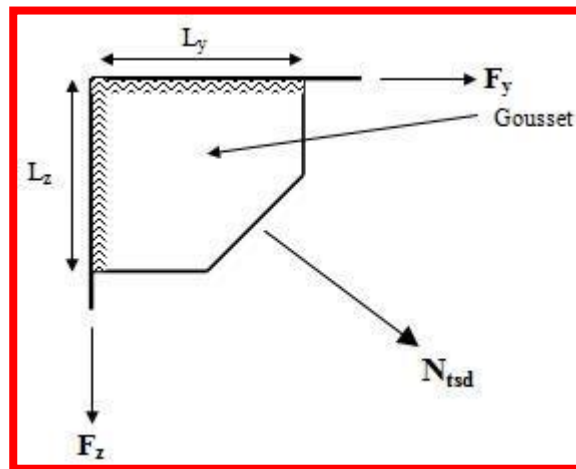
assemblage gousset nœud du portique par cordon de soudure.
